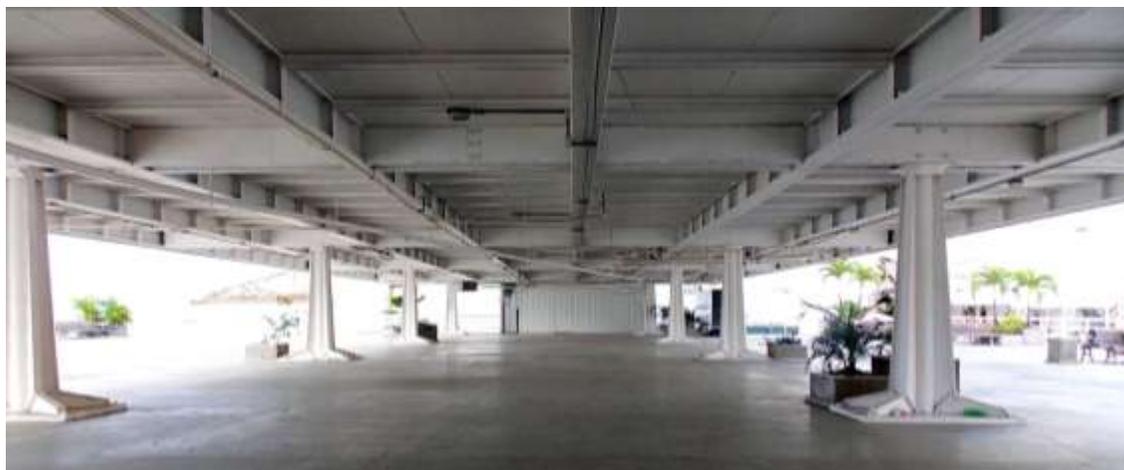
Vista dos pilotis em estrutura metálica aparente, atualmente pintada de branco. Foto: CANTALICE II.
